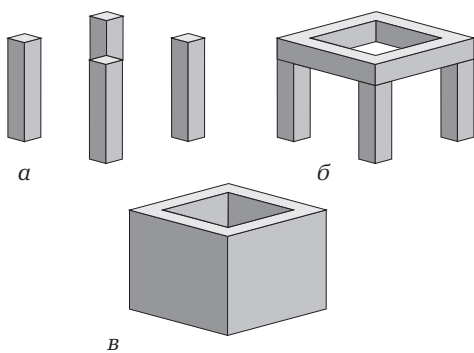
Рекомендуемые конструкции фундаментов по характеристикам грунтов: а — столбчатый фундамент; б — столбчатый фундамент с «башмаками» снизу и армированной бетонной перевязкой сверху; в — ленточный фундамент
